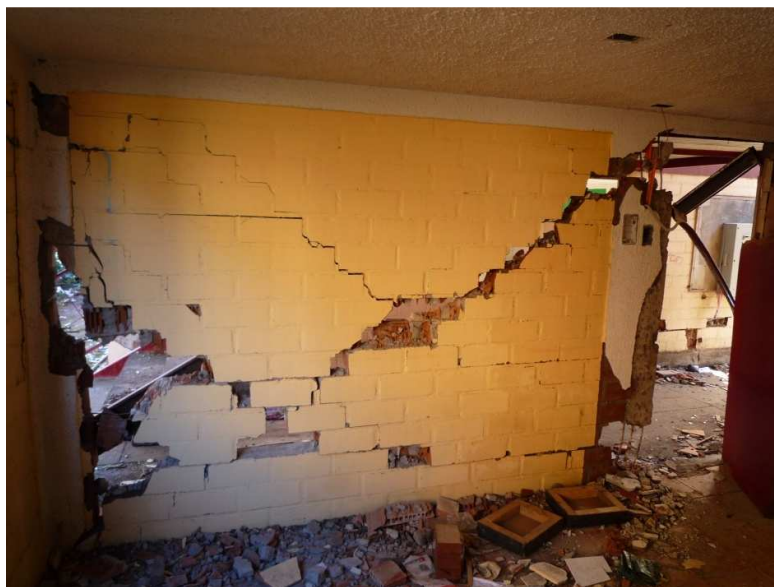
Daño severo en muro externo de albañilería confinada. Pilar derecho con armadura pandeada y pérdida total de hormigón en la parte superior e inferior.
